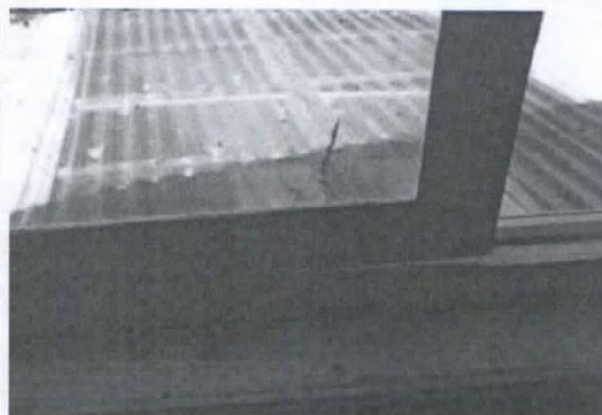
Fachada oriente sin la intervención proyectada.
